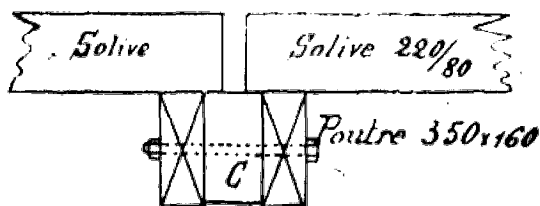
Disposition d'un plancher avec solives posées sur poutres jumelées.
